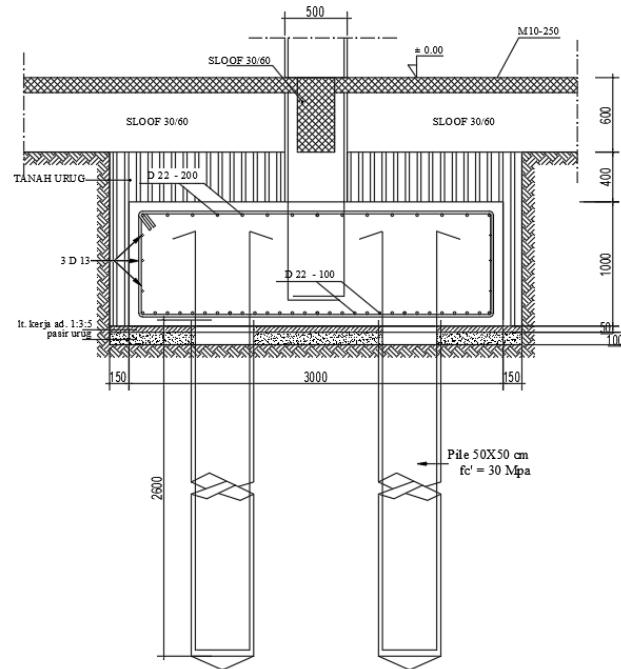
Detail Balok Sloof Arah Memanjang
